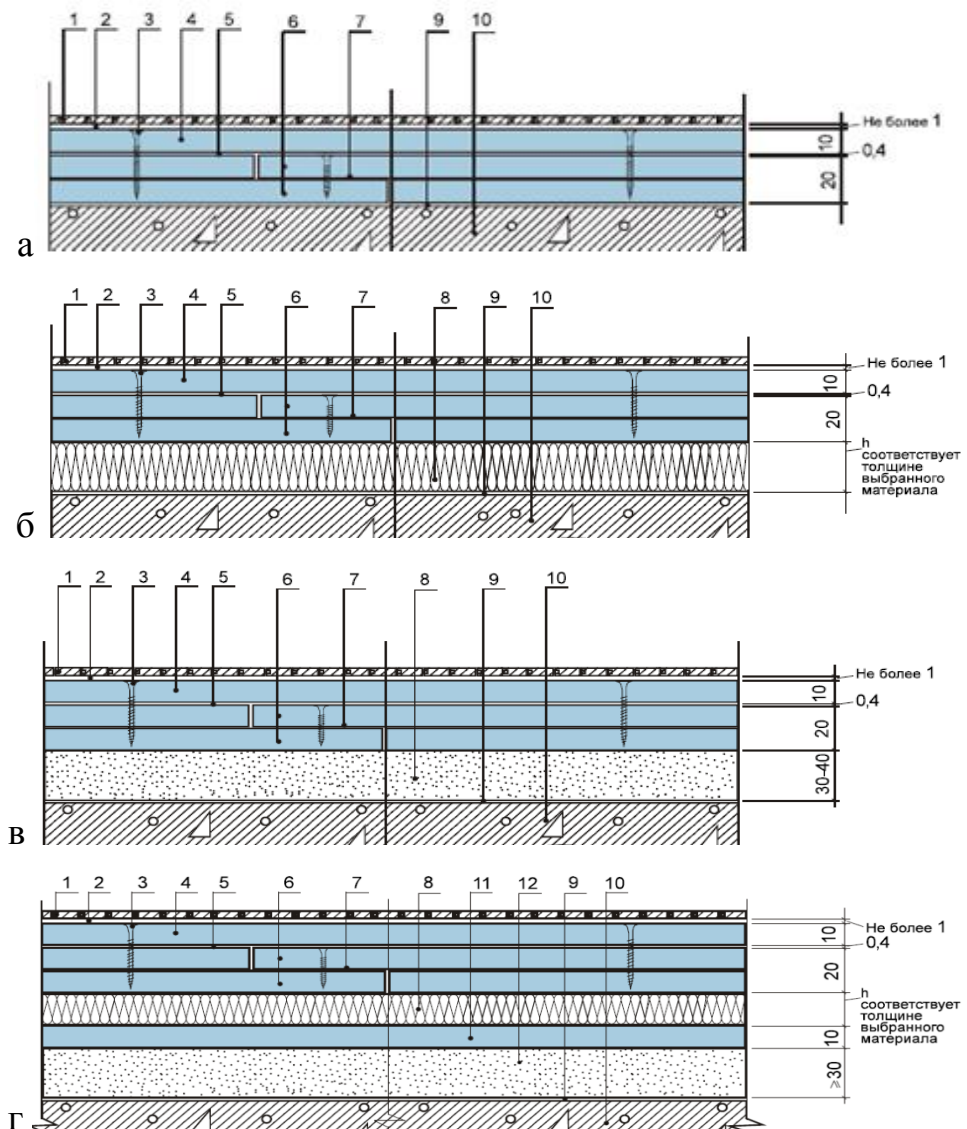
Конструктивні схеми підлог з покриттям з паркету штучного і набірного : а - тип конструкції "Альфа"; б - тип конструкції "Бета";
